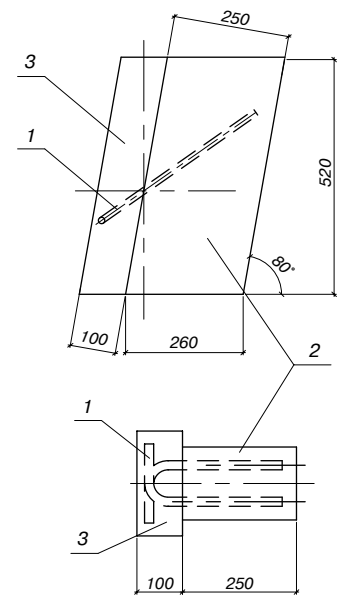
Конструкция опытного образца: 1 – петлевой анкер; 2 – клееная древесина; 3 – бетон
